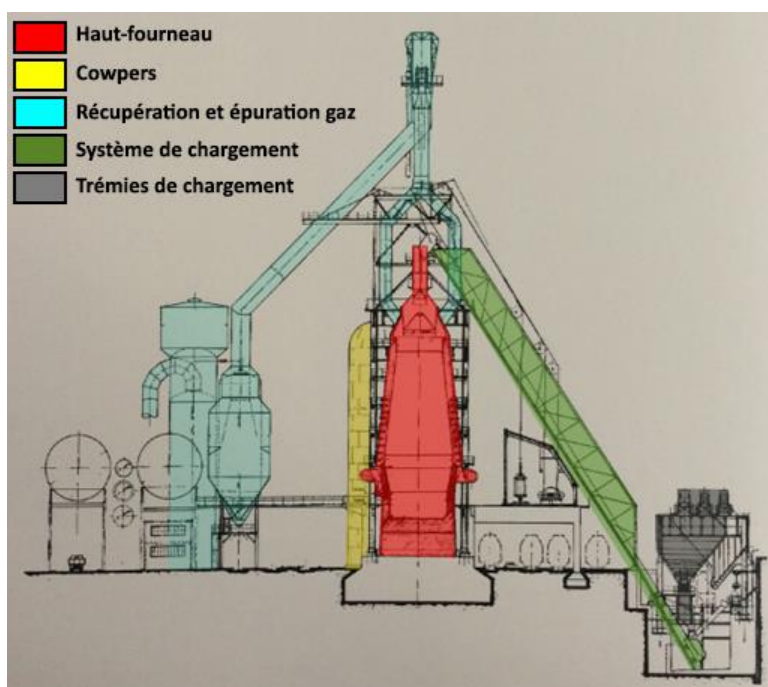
Schéma de profil du haut-fourneau B en 1962
